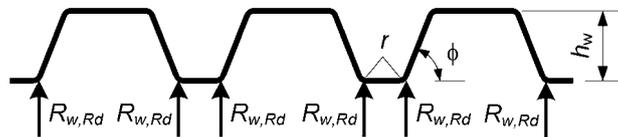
Beispiel eines Querschnittes mit zwei oder mehr Stegen
